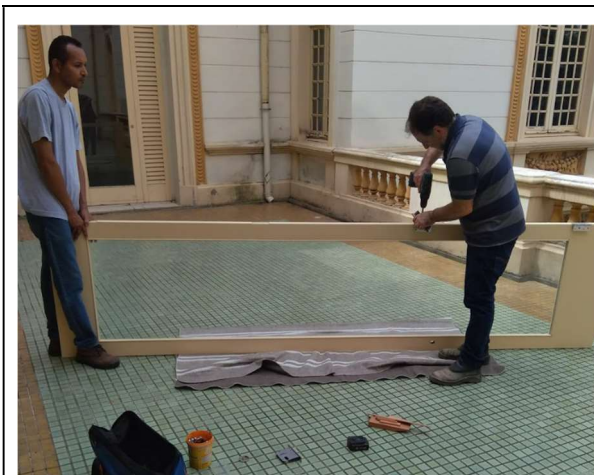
Manutenção corretiva, porta de acesso à varanda primeiro pavimento.
